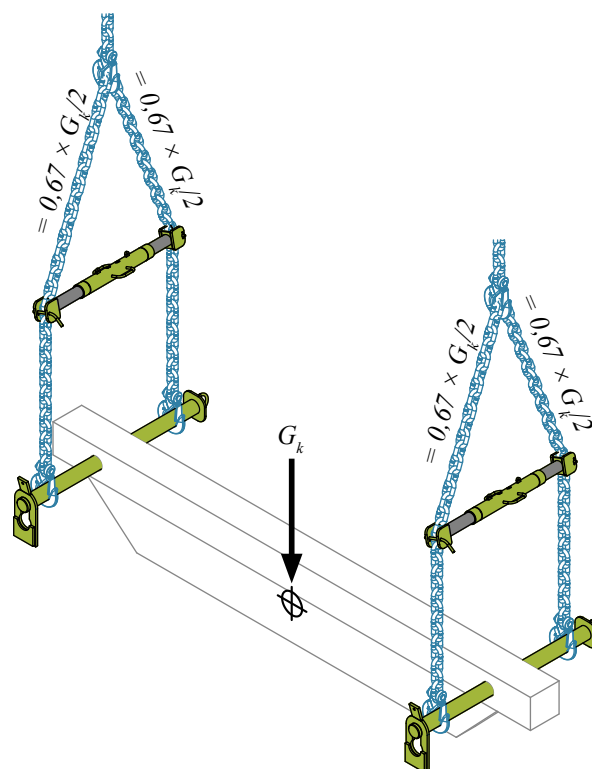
Capacità minima per un tirante dell'imbracatura con una trave prefabbricata.
